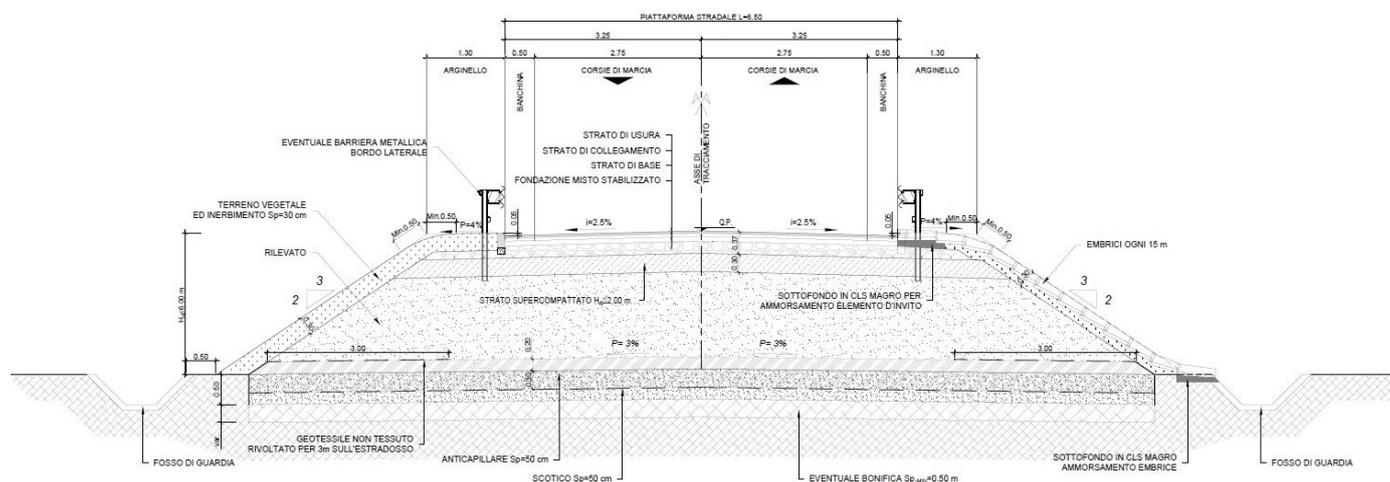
Dest. Particolare 6.5m – sezione tipo in rilevato $H_{ril} \leq 6.00$ m
